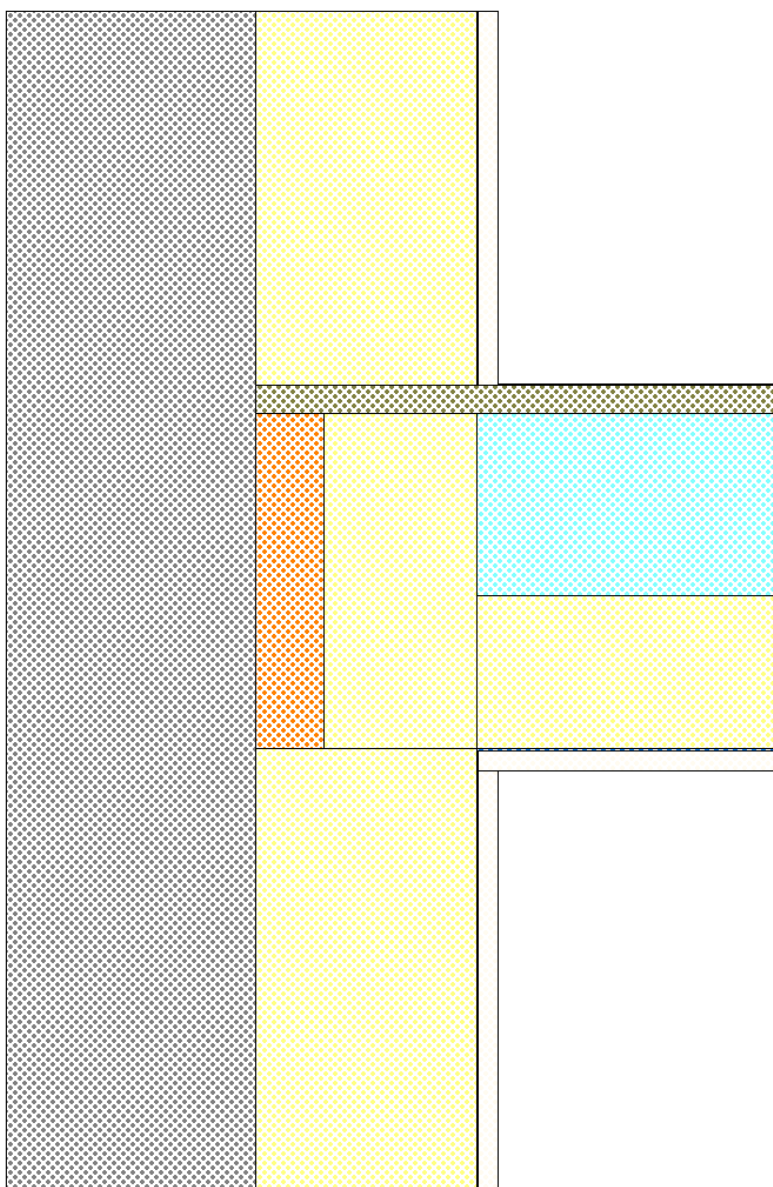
Configuration liaison plancher bois / mur béton avec ITI
